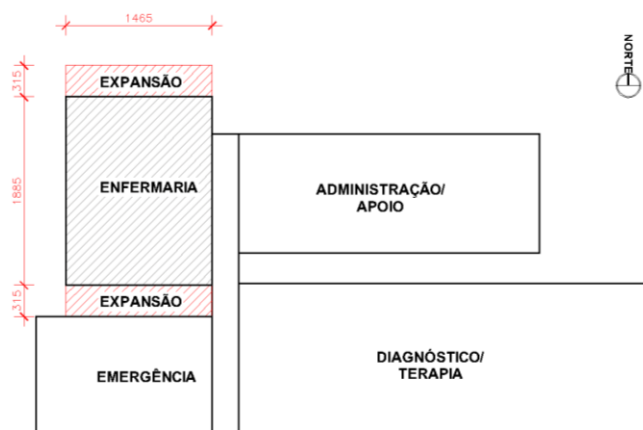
Planta baixa caso 5, expansão dos blocos adjacentes.
